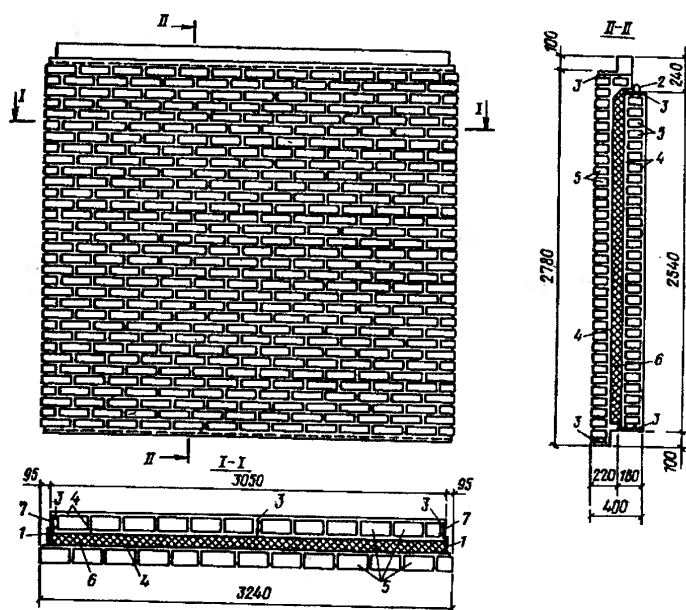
Наружная стеновая панель: 1 – гибкая связь; 2 – монтажная петля; 3 – арматурный каркас; 4 – растворный слой; 5 – кирпич; 6 – плитный утеплитель; 7 – накладка, привариваемая электродуговой сваркой
